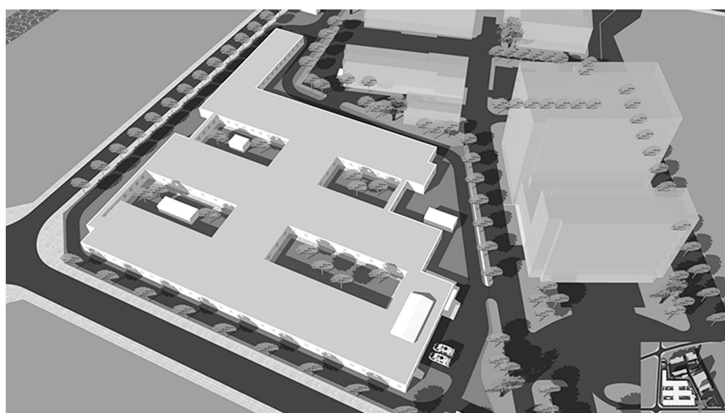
深圳市第三人民医院二期工程应急病区总平面图
